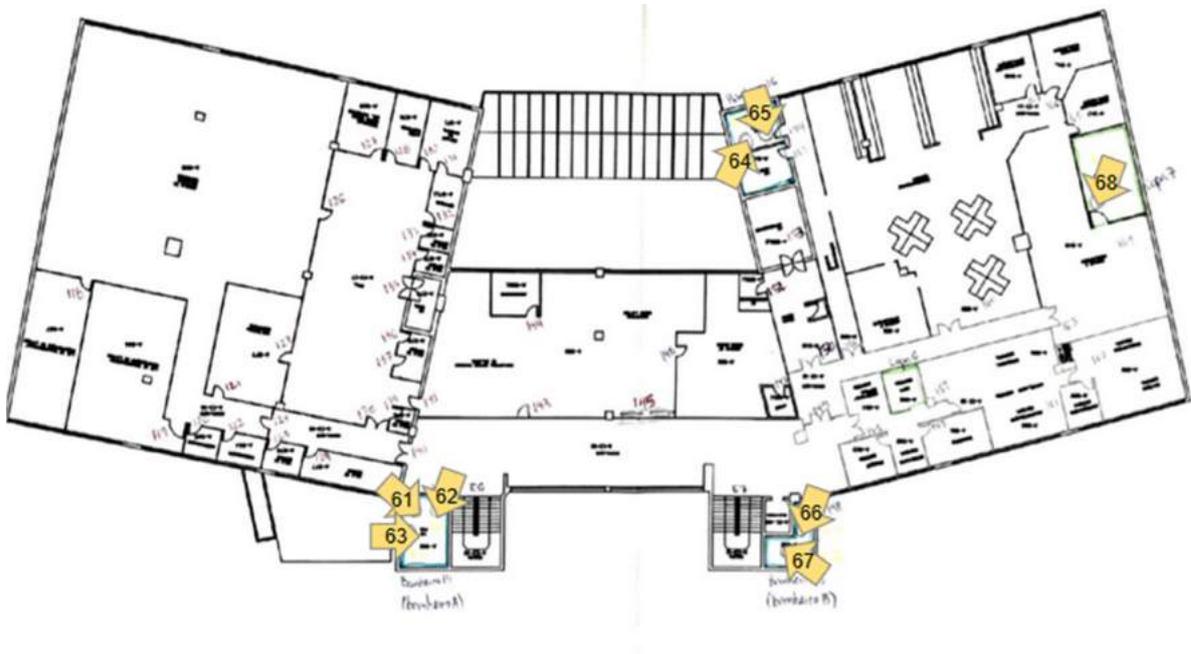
Planta da BCCL – terceiro pavimento– Montagem Autor: Dutra, P. 2020
